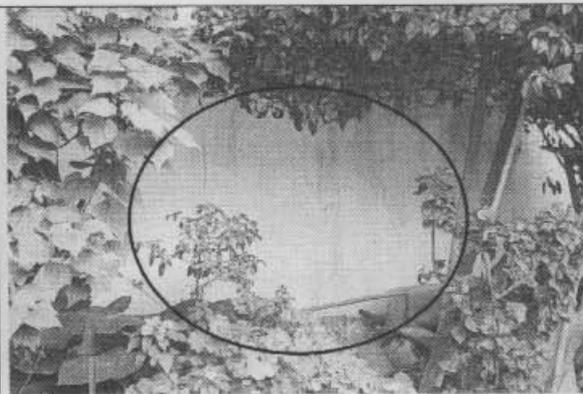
Fisuras superficiales sobre el muro de antejardín correspondiente al costado occidental del inmueble.
